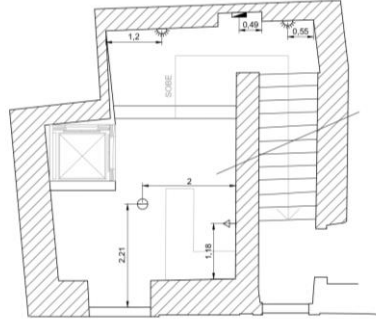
Planta de vermelhos e amarelos- segundo andar
